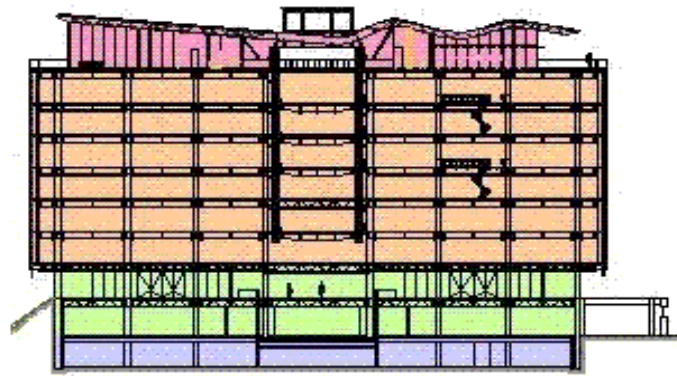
Distribución de los niveles en la Torre de Ingeniería
